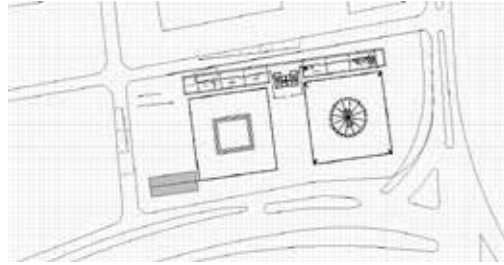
Planta Conjunto - Nivel ± 0.00 (2016)
